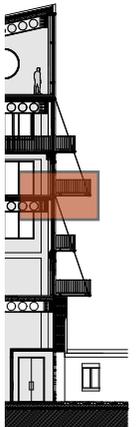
Balkondetail – Anschluss Galeriegeschoss
